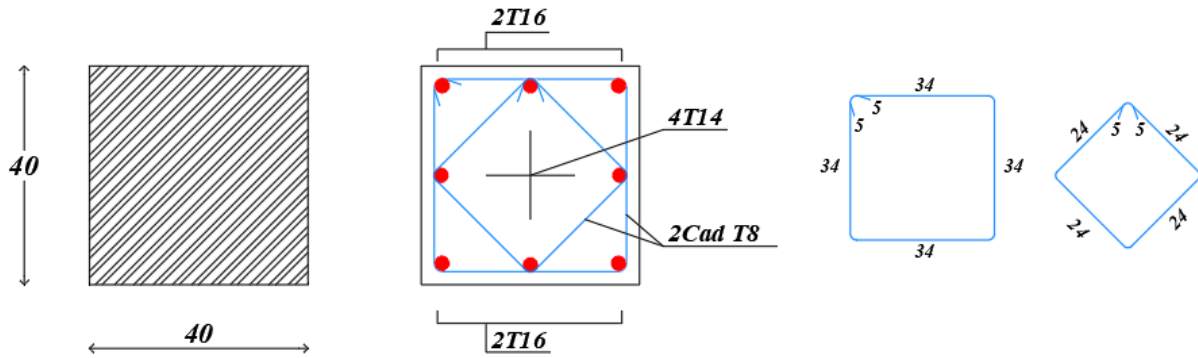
Schéma de ferrailage des poteaux (40x40)
